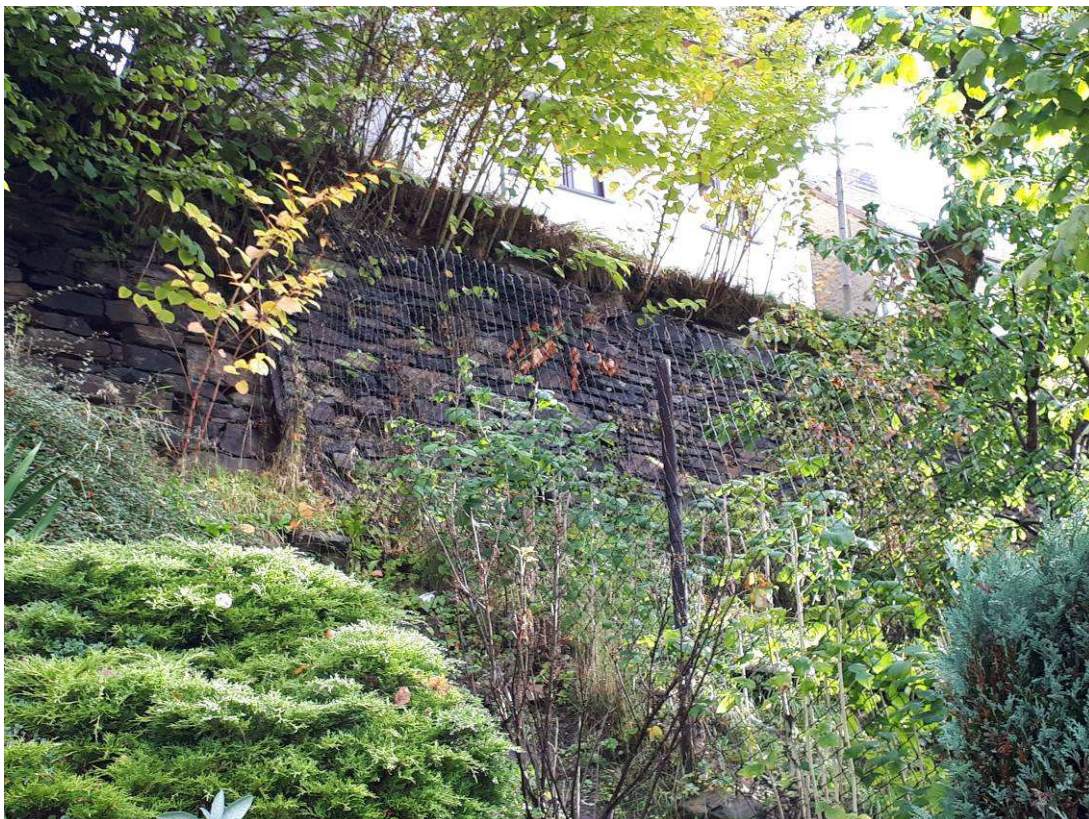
detail zřícené části opěrné zdi, patrné úplné rozvolnění kusového zdiva – kamenů ve zdivu a vypadnutí části zdi
